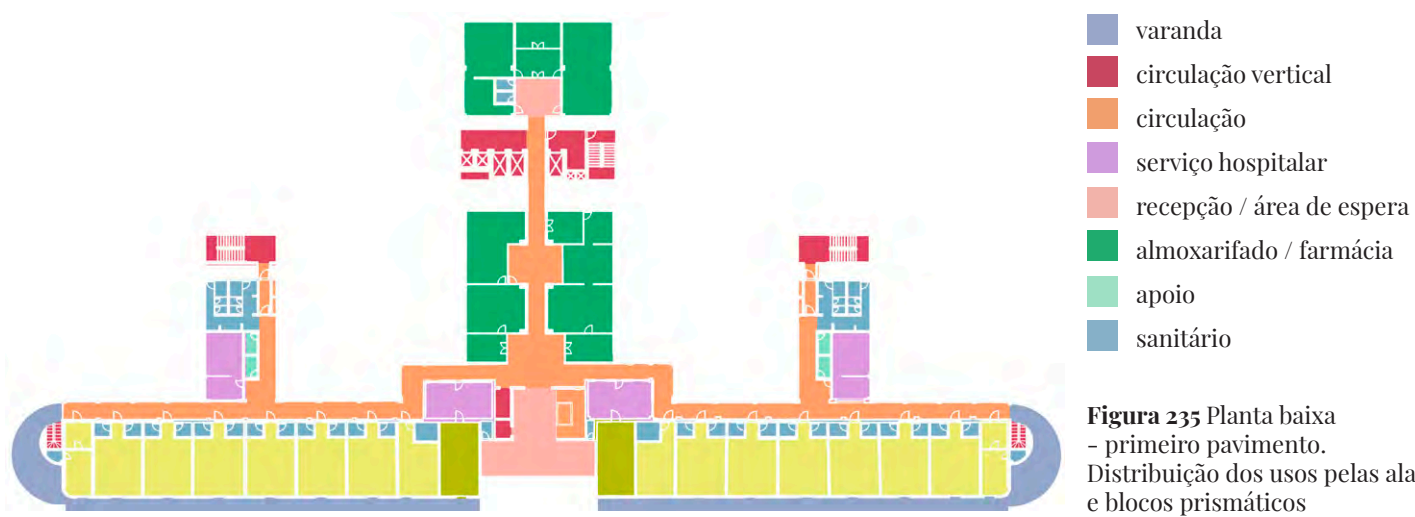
Planta baixa - primeiro pavimento. Distribuição dos usos pelas alas e blocos prismáticos
